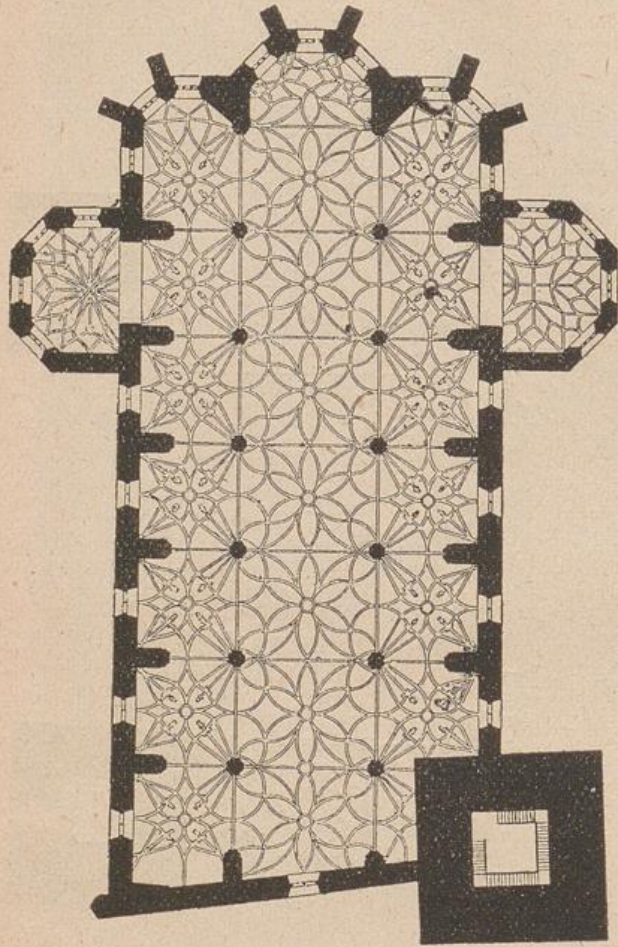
Annenkirche. Grundriß mit Sterngewölben.
